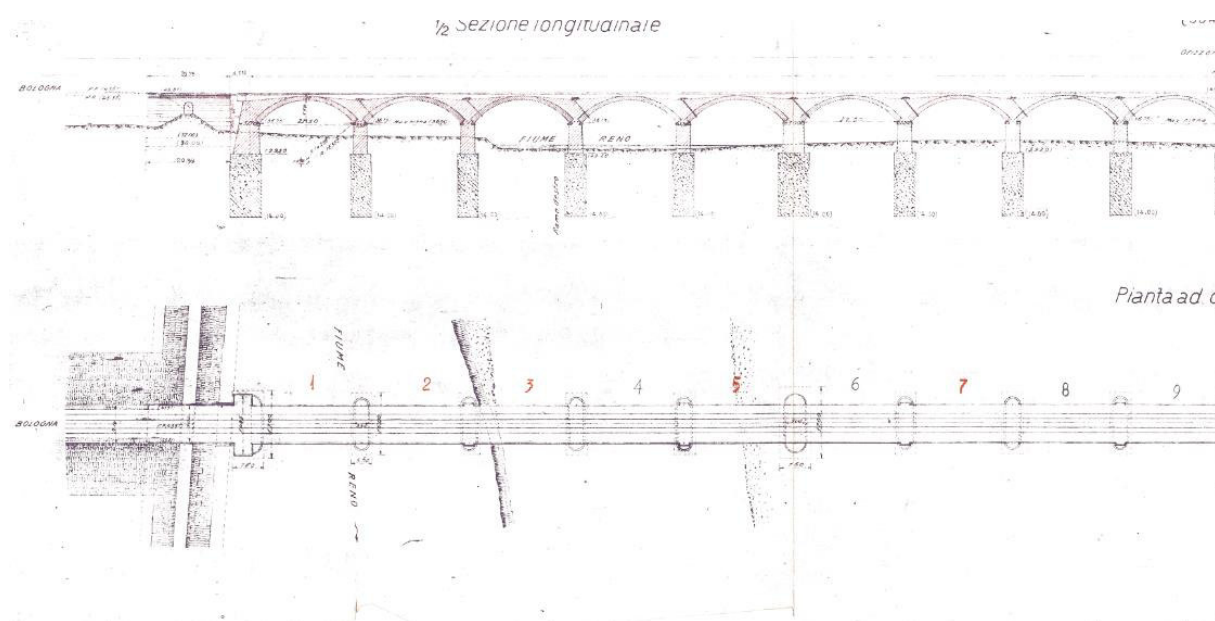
Prospetto Ponte ad archi di Cintura (Archivio Storico RFI)
